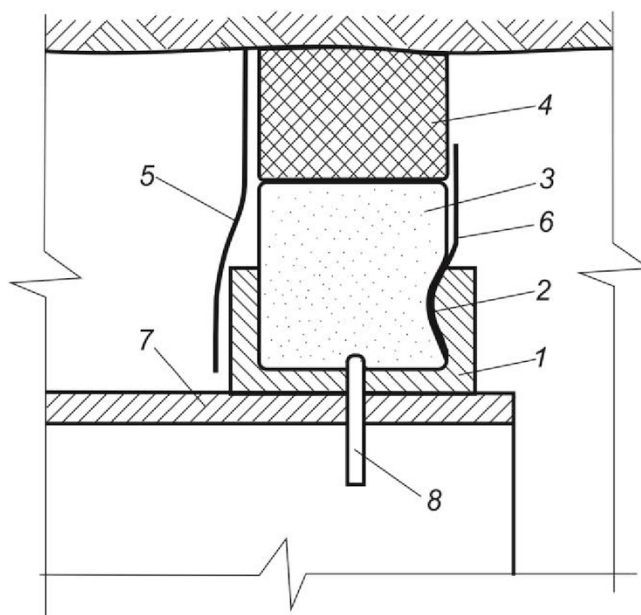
Торцовый герметизатор опалубки для бетонирования обделки выработок
